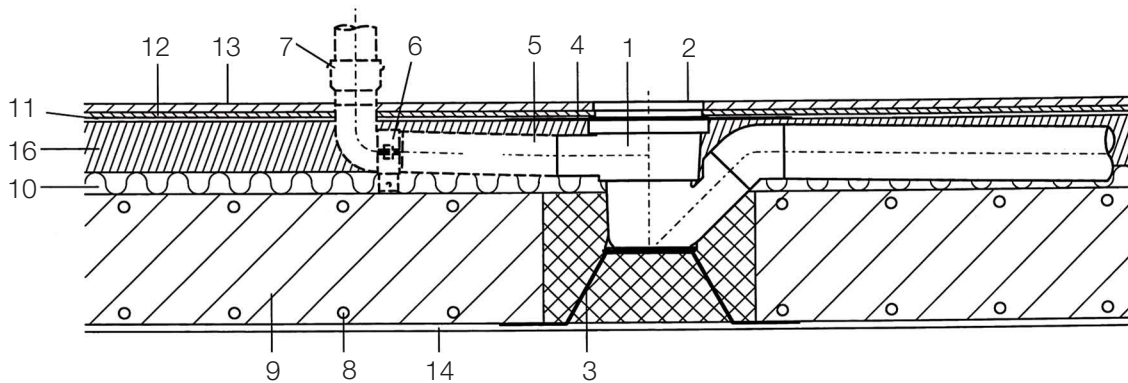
Einbau in Aussparung montiert mit Anschlussblech, Boden aus PVC-Bahnen
